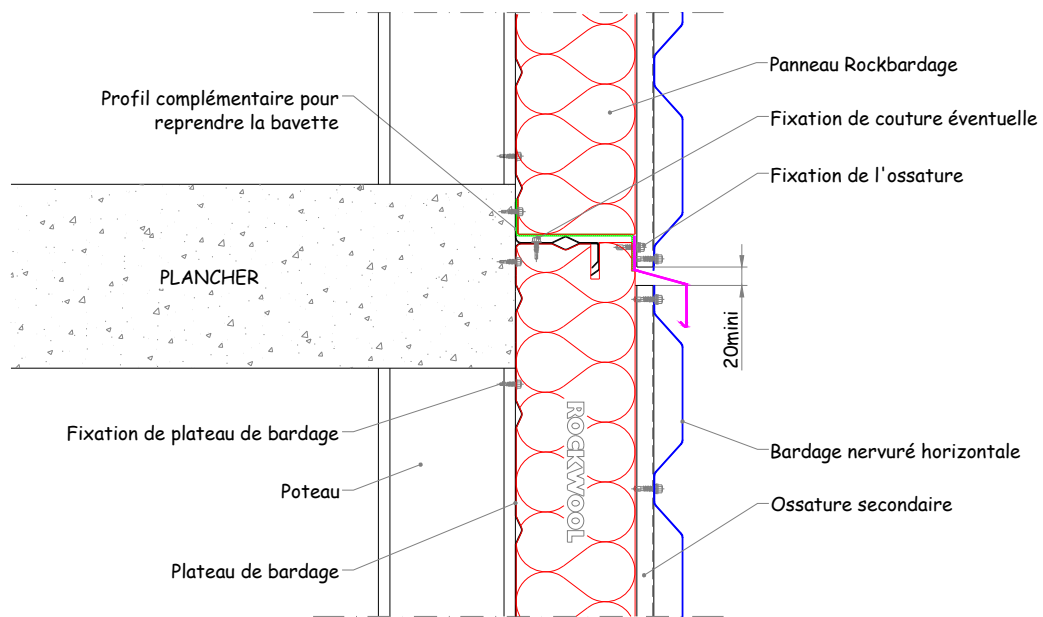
Exemple d'interruption d'ossature au droit d'un plancher en zones sismiques
